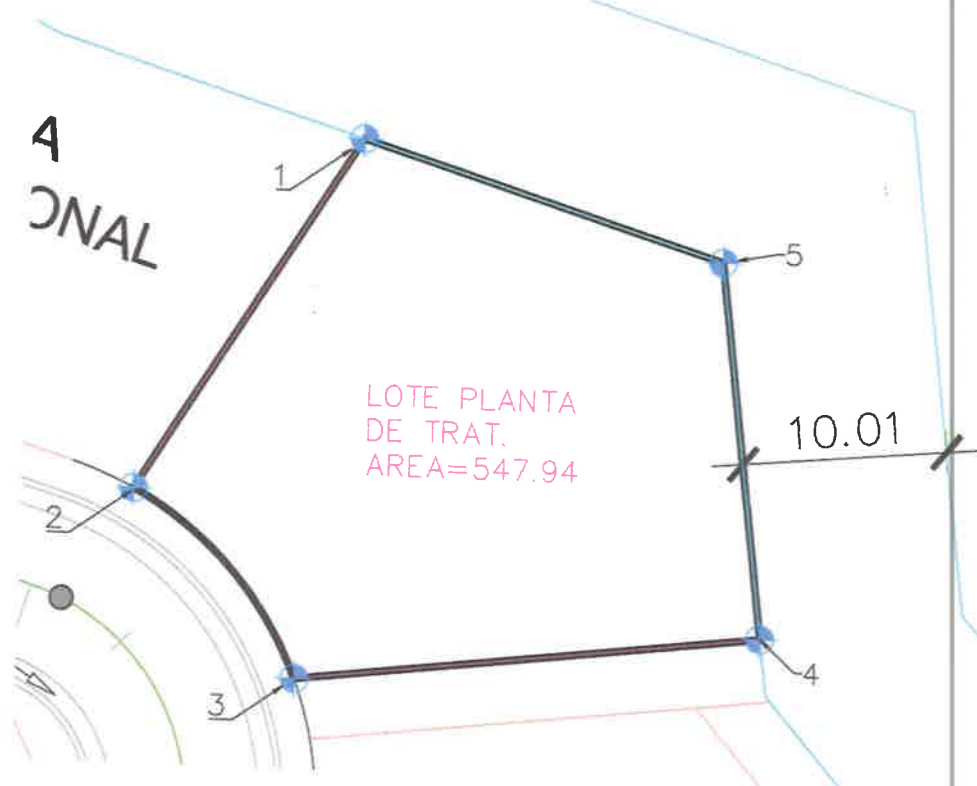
Polígono del LOTE LLAMADO PLANTA DE TRATAMIENTO EN PLANOS (547.94 m²).
